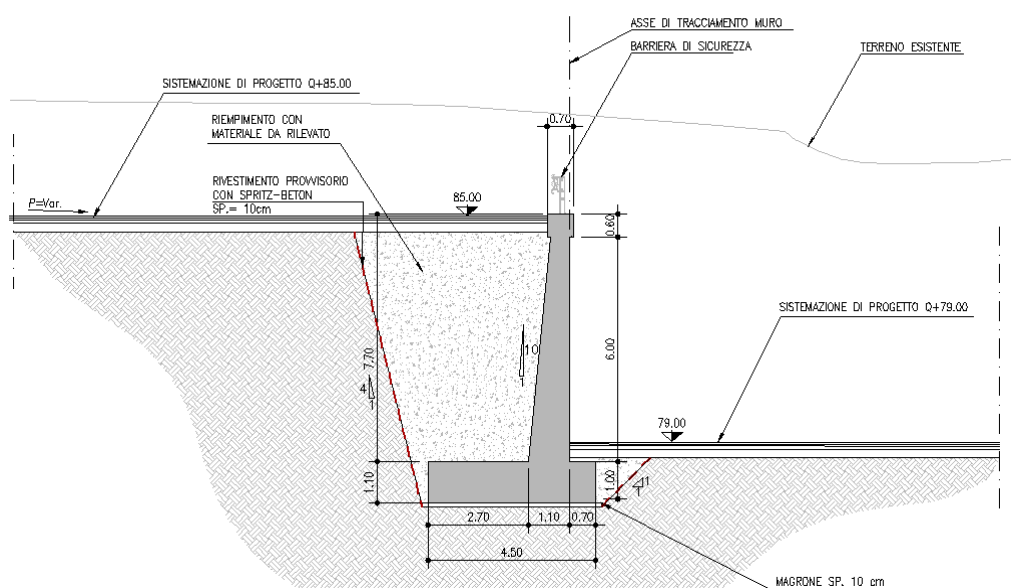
Muro di sostegno MS01 – Sezione tipo 1
